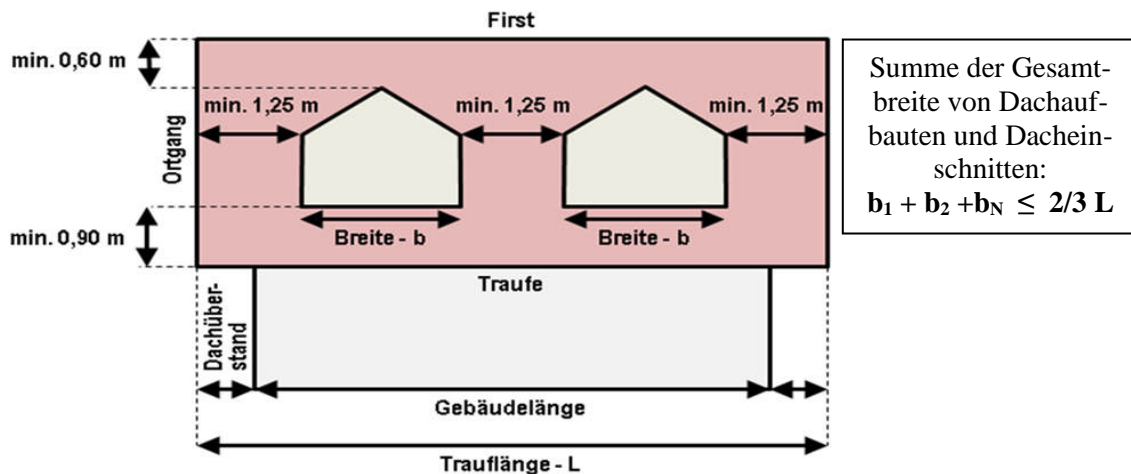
Abmessungen zulässiger Dachgauben (hier Beispiel: Sattelgaube)
